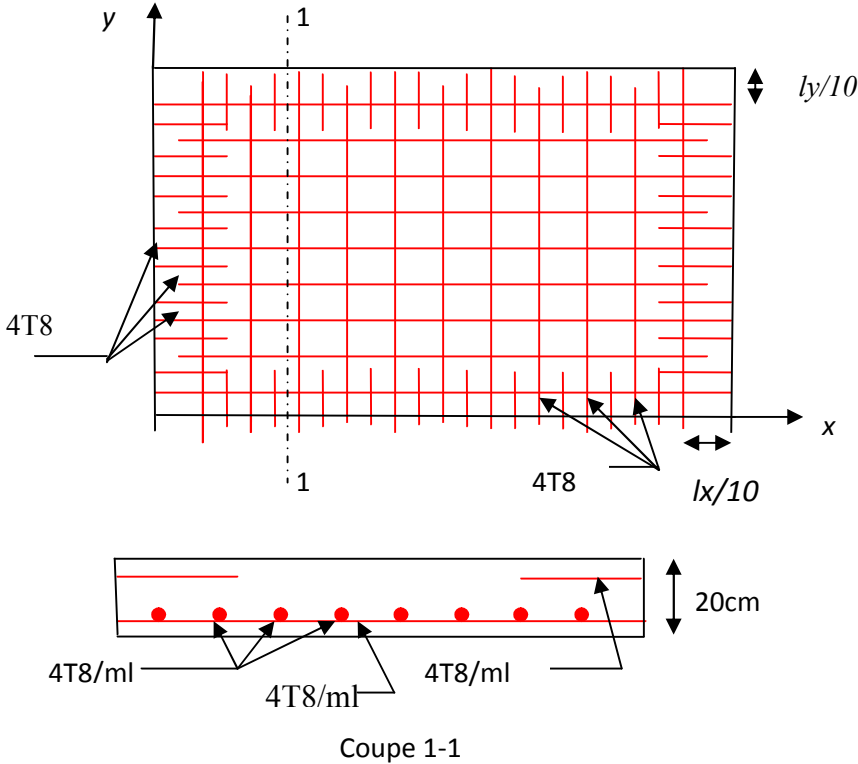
Schéma du ferrailage de la dalle du locale de machine.
